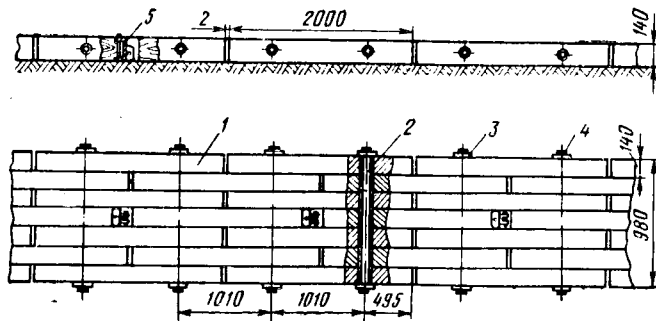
Конструкция ленточного сборно-разборного покрытия:
